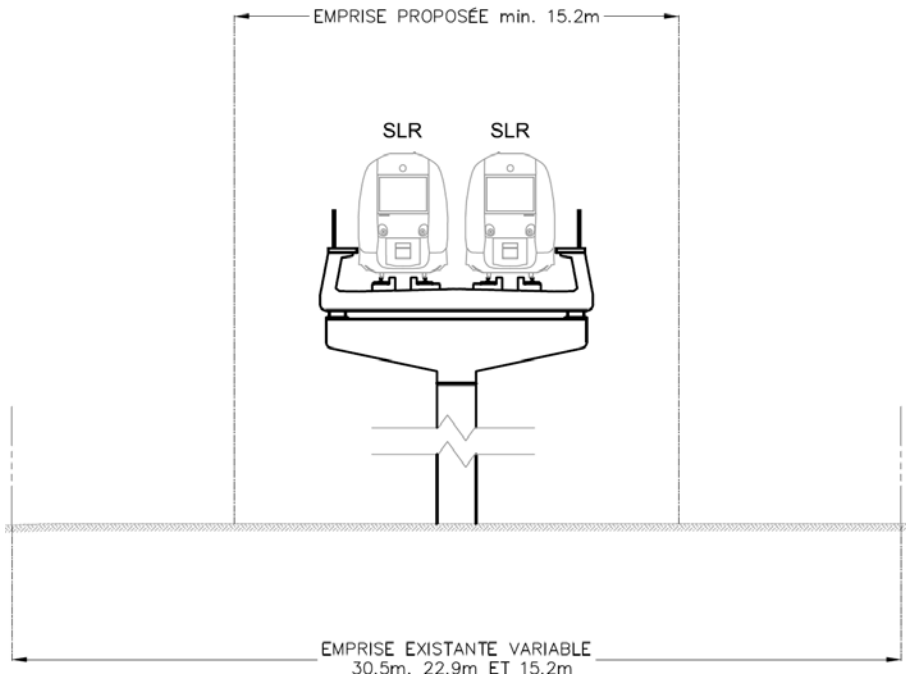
Exemple de coupe typique d'une structure élevée
